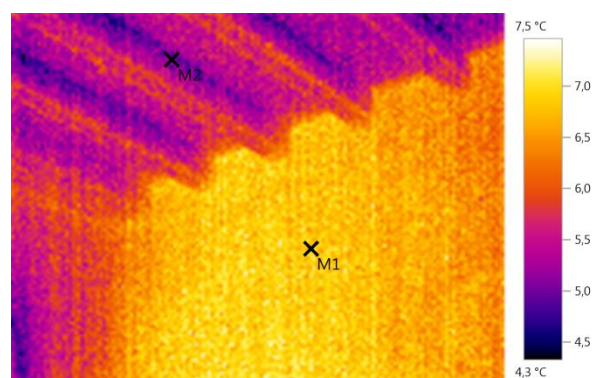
Außenaufnahme im Bereich der Durchfahrt – ungedämmte oberste Stahlbeton-Geschossdecke und Außenwand
